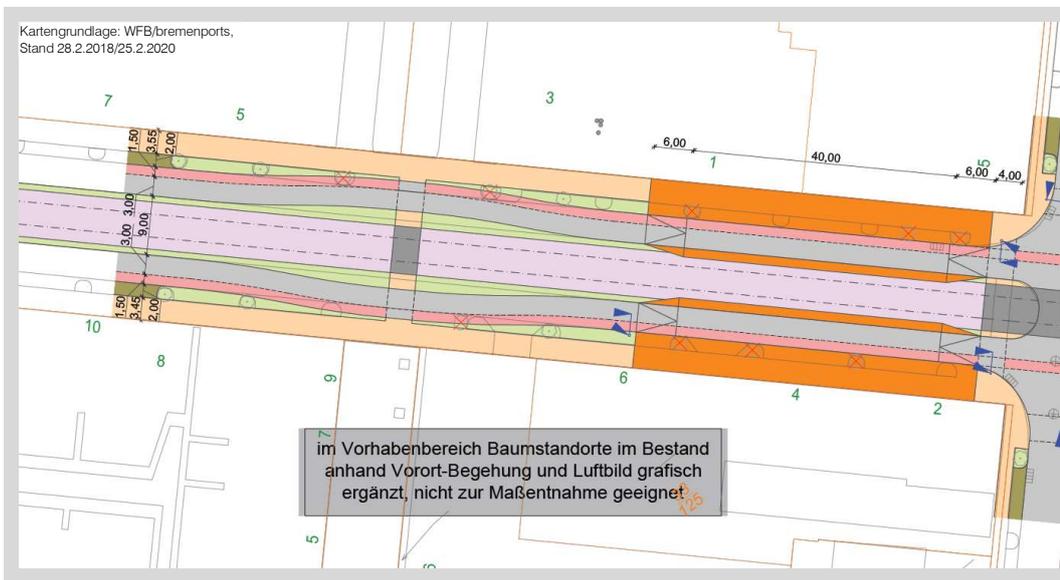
Ausschnitt Lageplan Haltestelle Nähe Überseepark
